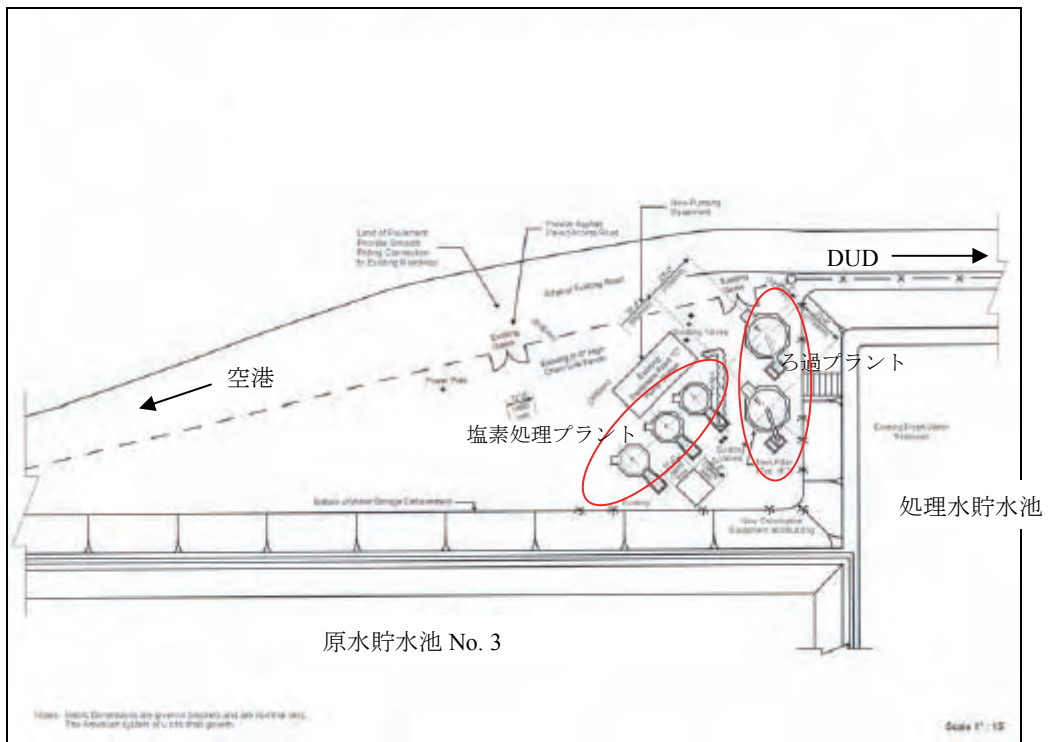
浄水場 C (処理プラント部) 平面図
